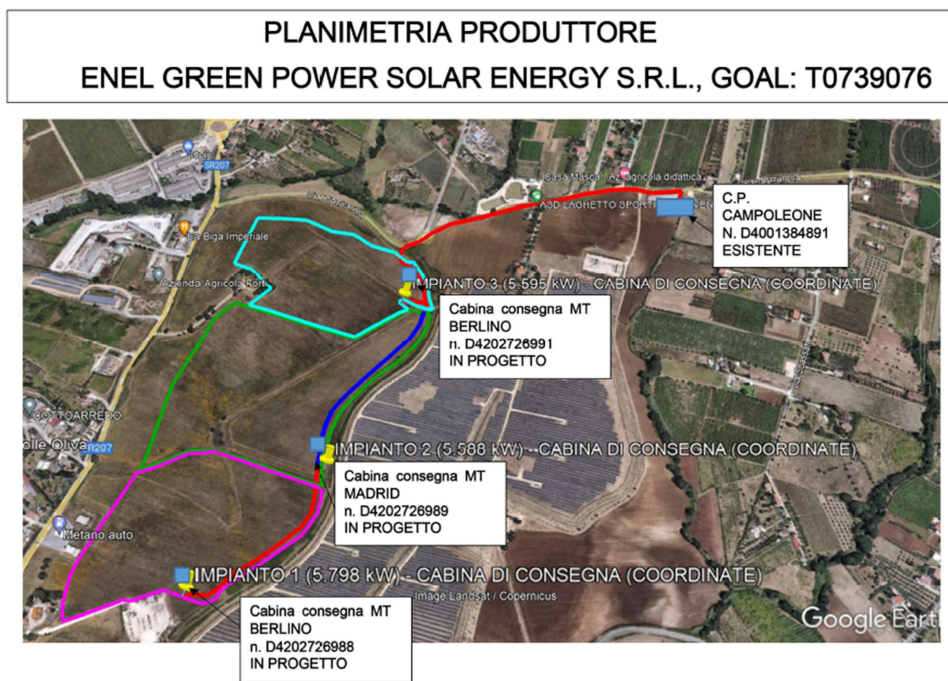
Ubicazione cabine di consegna e tracciato cavidotti di connessione alla CP Campoleone secondo planimetrie STMG. In magenta, in verde e in ciano è riportata rispettivamente la suddivisione del lotto di
